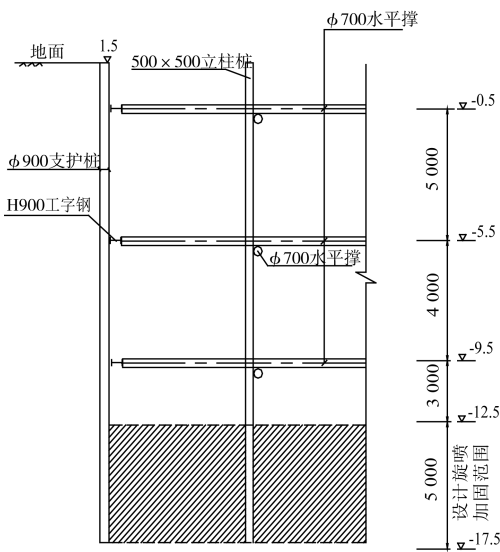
基坑支护立面结构 (尺寸: mm; 高程: m)
